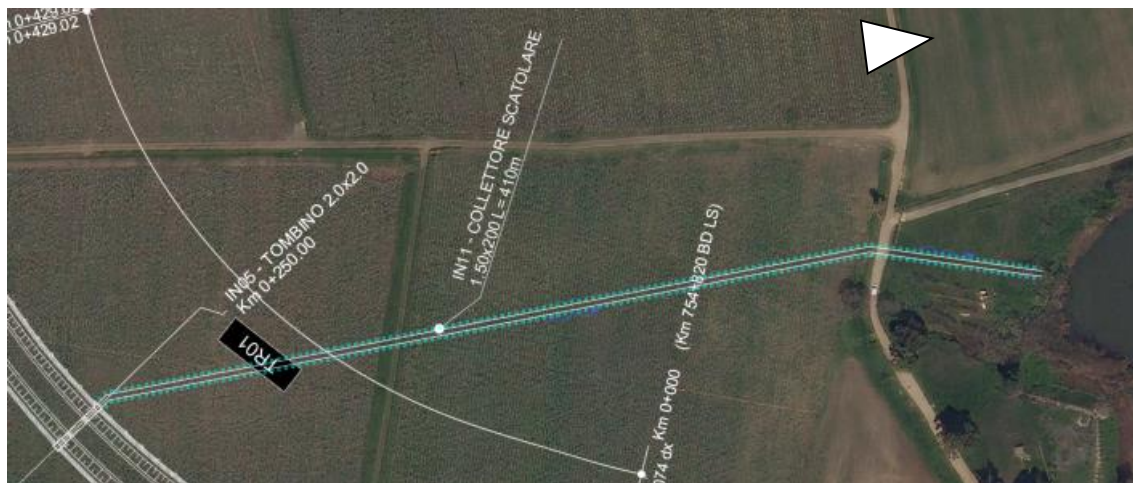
Inquadramento planimetrico del collettore IN11. In ciano le siepi di nuovo impianto previste nel progetto delle opere a verde
